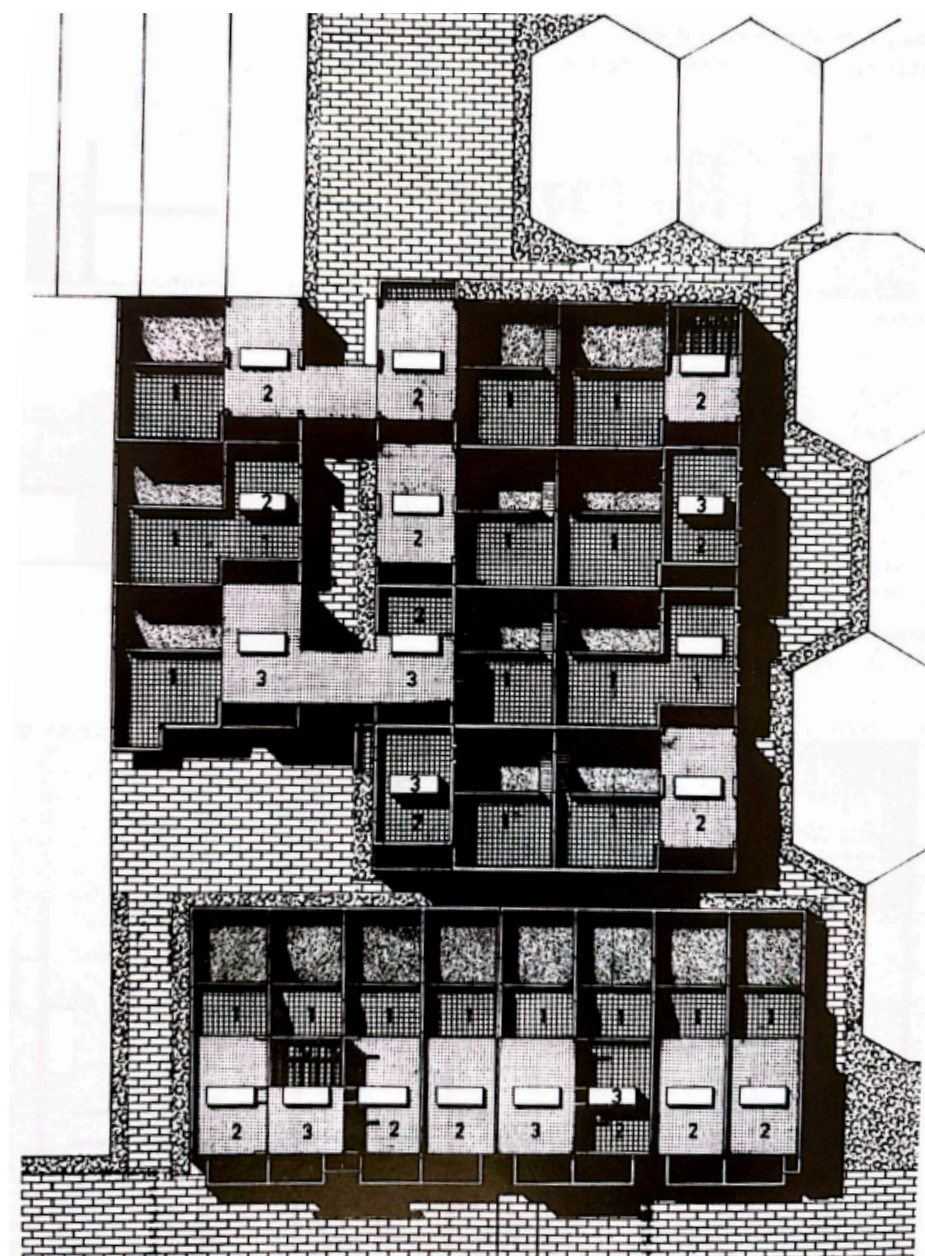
Plano de cubiertas y alturas de edificación para PREVI
